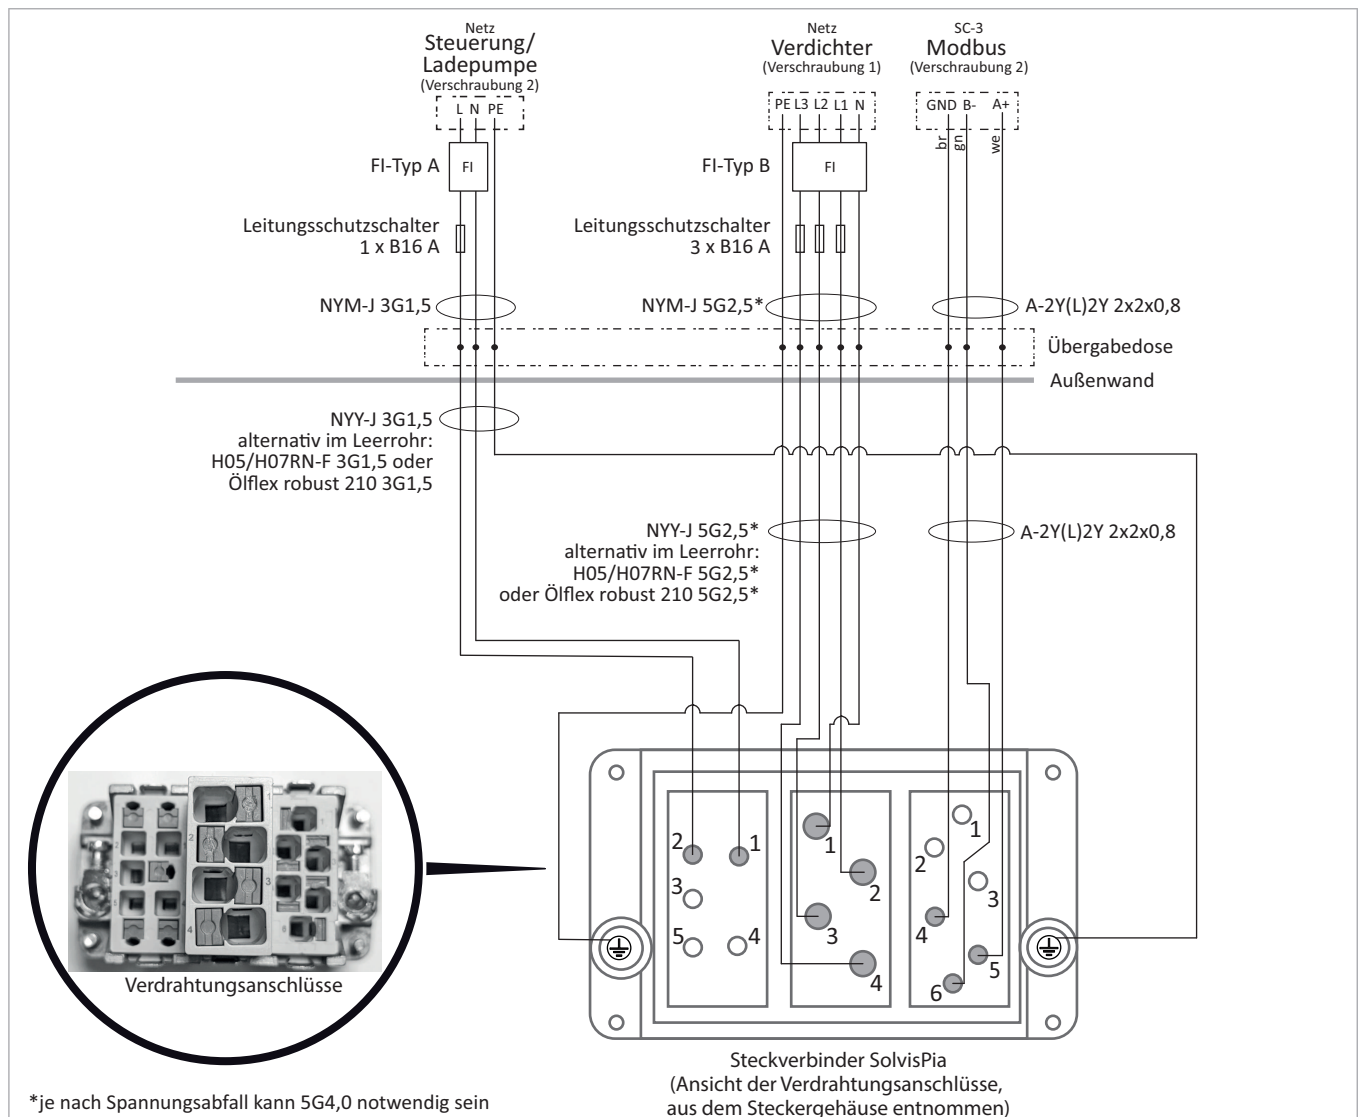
Stecker-/Anschlussbelegungsplan SolvisPia 12
